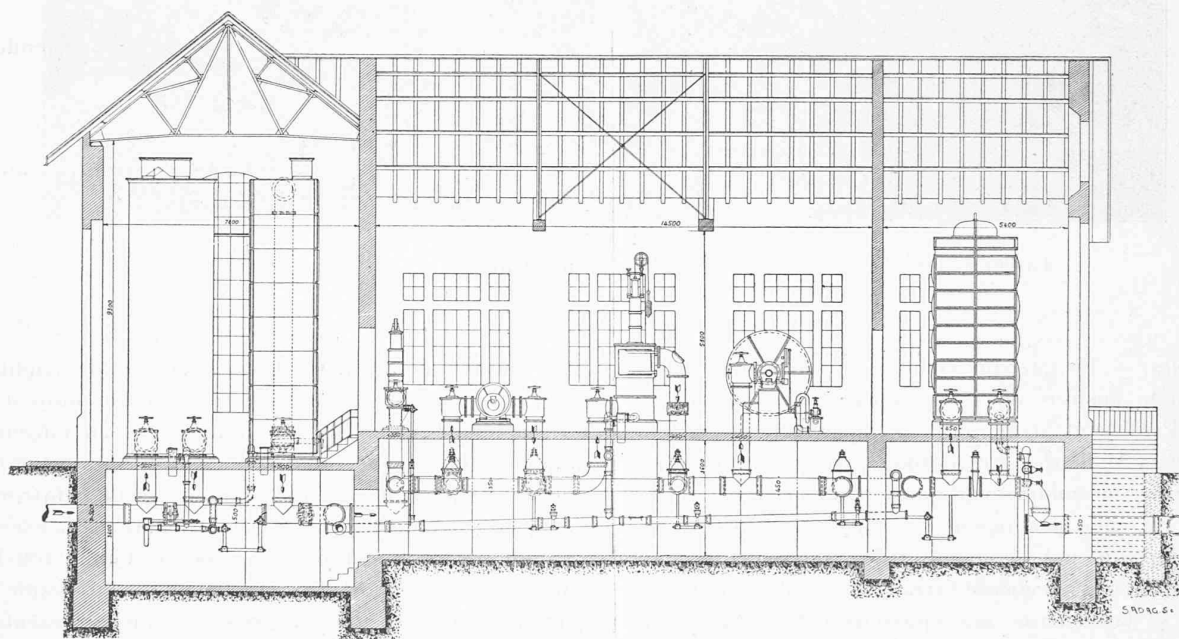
Coupe longitudinale du bâtiment des appareils.
